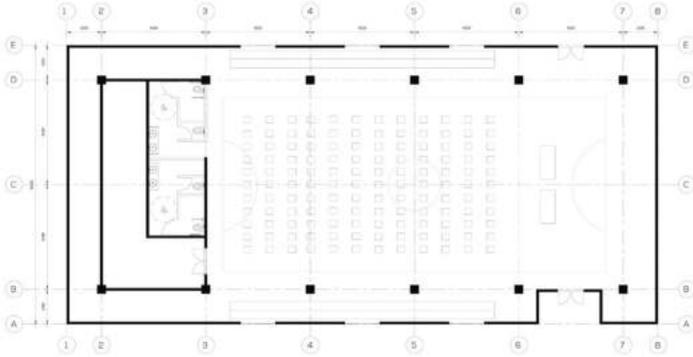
Gimnasio, planta de distribución para modalidad de auditorio.
